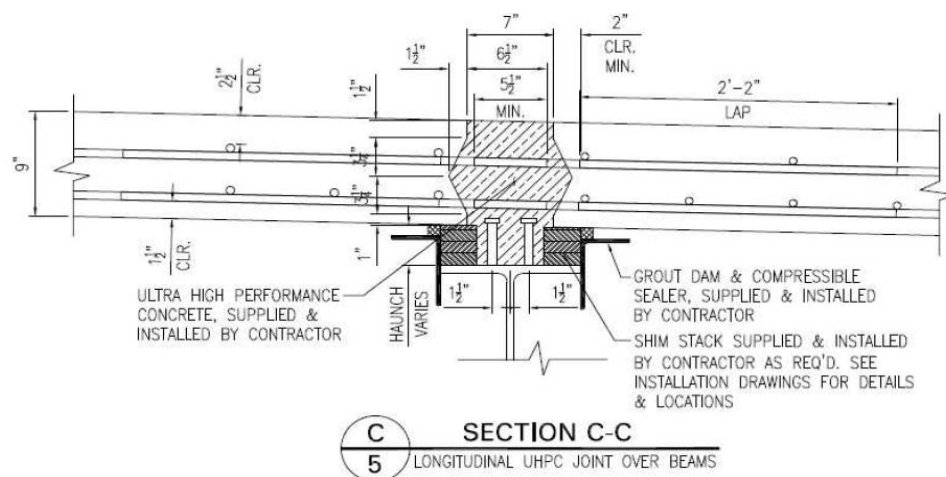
Joint longitudinal entre deux dalles préfabriquées et une poutre en acier (Culmo, 2009)
